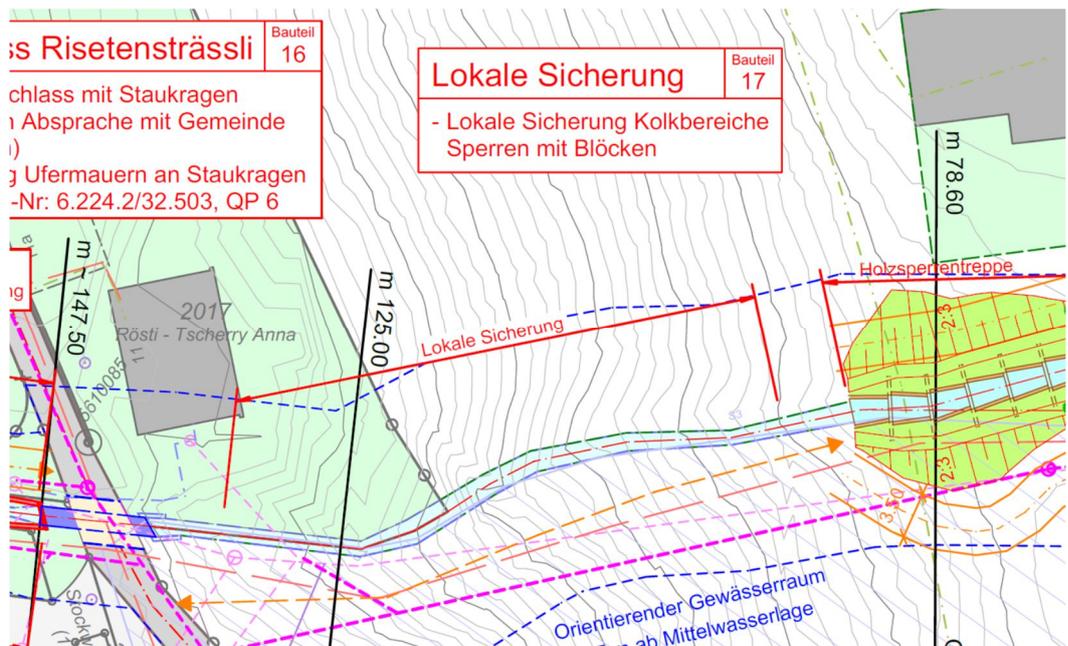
Situation Bereich Steilstrecke nach Brücke Risetensträssli, lokale Sohlensicherung in der Steilstrecke
